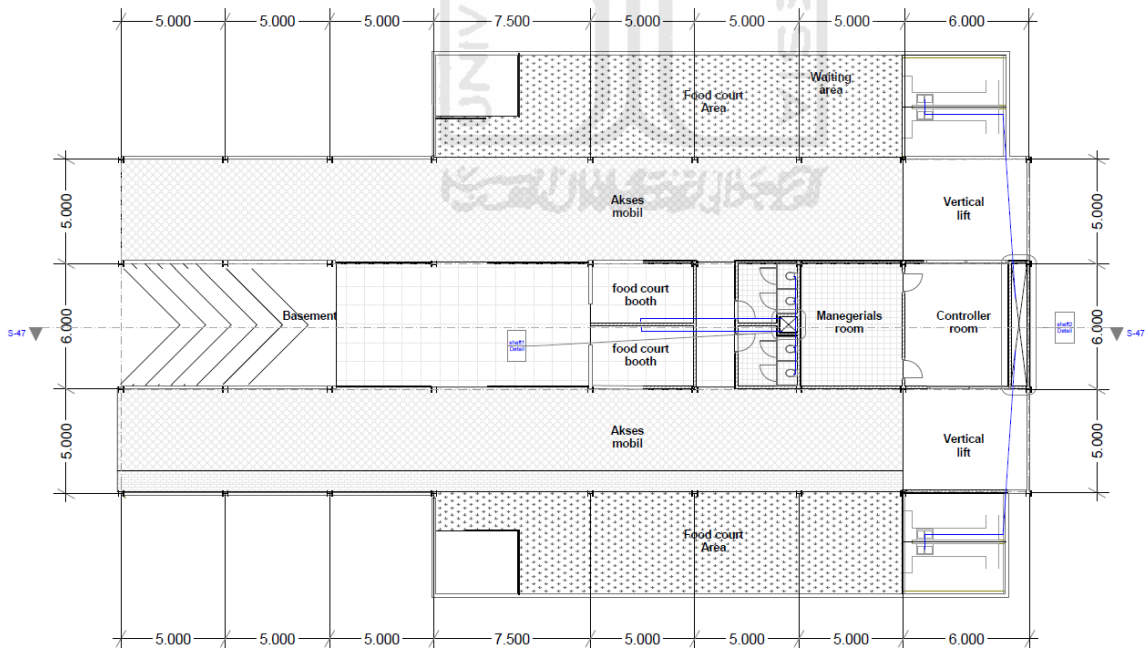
listrik groundfloor (sumber: analisa penulis)
